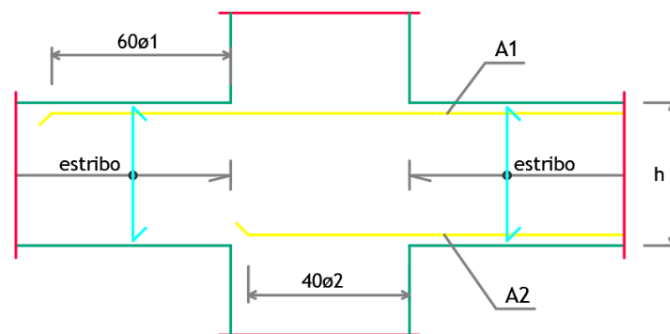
Amarração da armadura longitudinal junto a um apoio intermédio (Projeto de estruturas).
